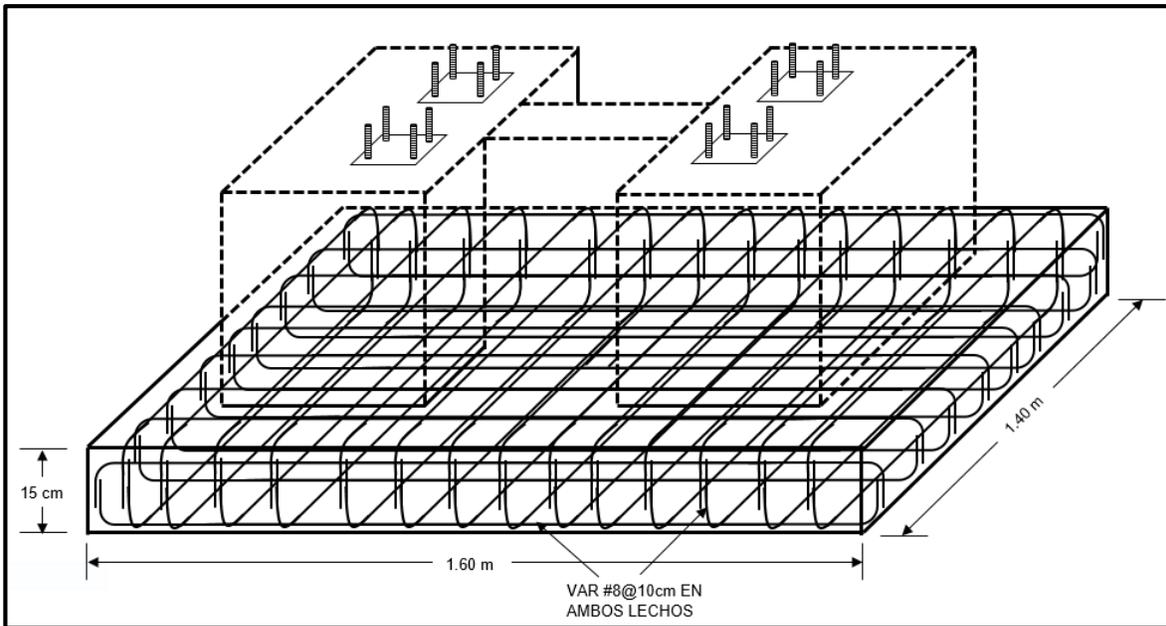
Armado de la losa zapata aislada parte de la Cimentación de la Estructura Mayor
